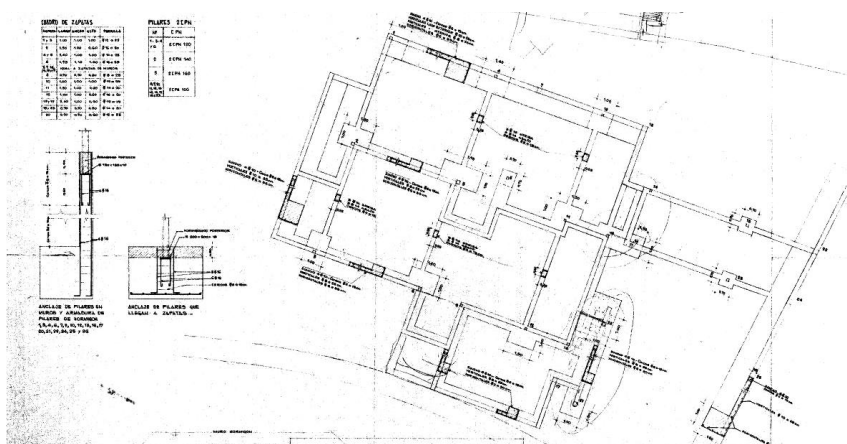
Planta, cuadros y detalles de cimentación. Autor: Empresa Odein, Fundación Alejandro de la Sota
